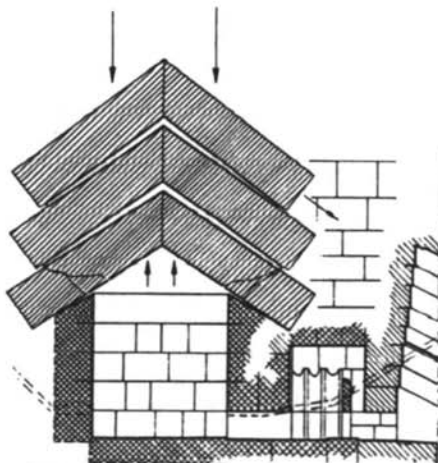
La Cámara del Rey desprovista de sus cinco techos planos. Fragilidad de las vigas apoyadas, ante empujes ascendentes
